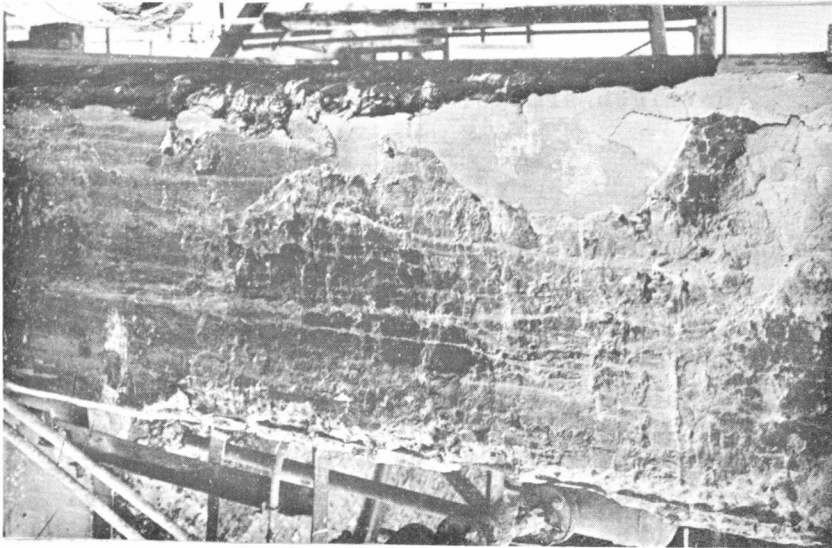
Estructura de hormigón armado afectada por el fuego
